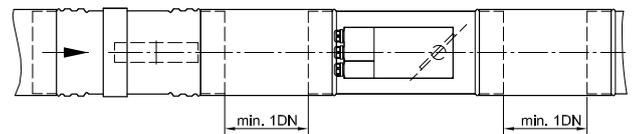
Einbau nach Störstelle, z.B. Brandschutzklappe
